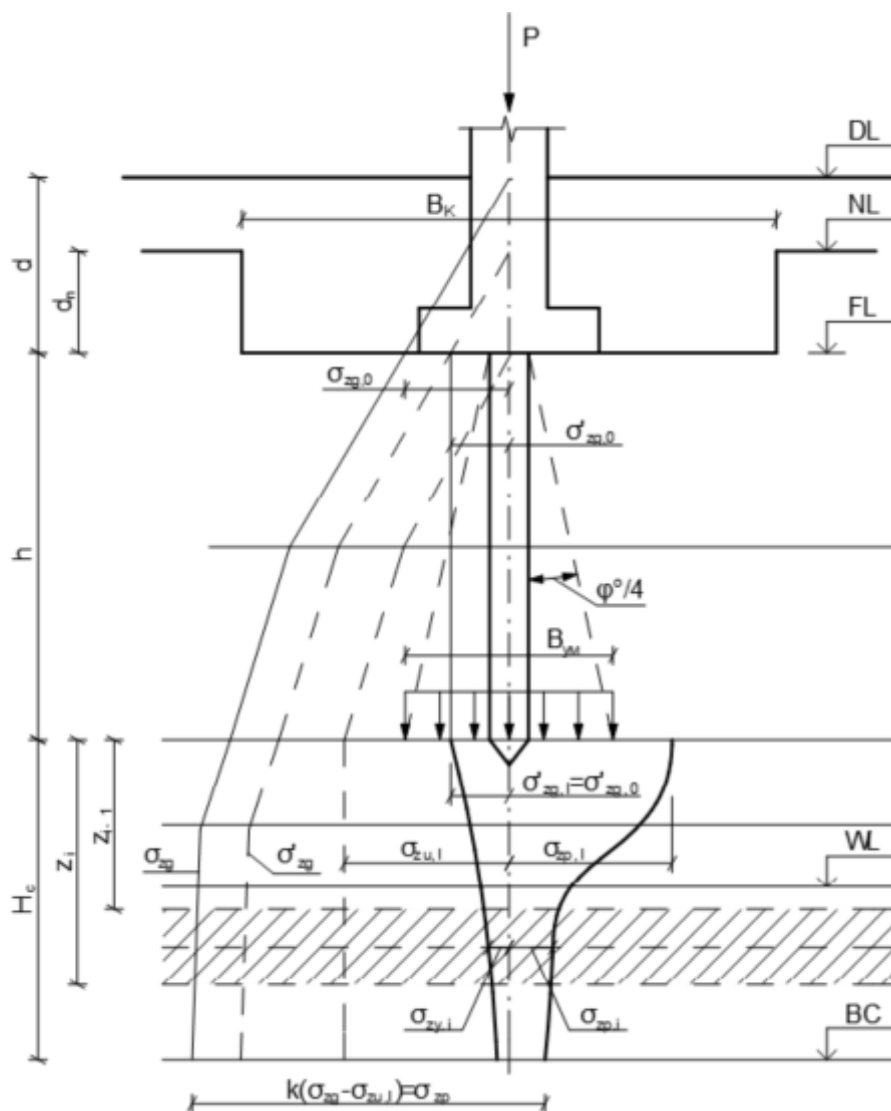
Схема розрахунку пального фундаменту за деформаціями основ
